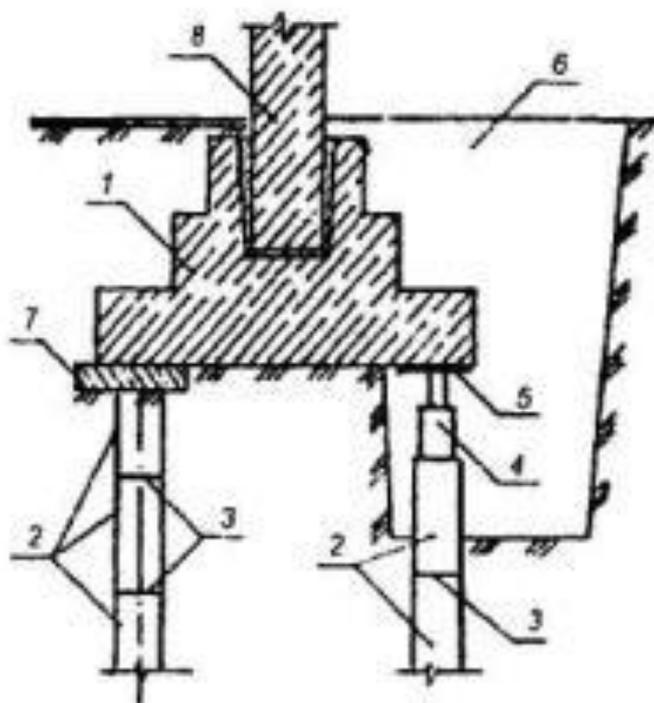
1 - усиливаемый столбчатый фундамент; 2 - звенья составных железобетонных свай: 3 - стыки свай; 4 - гидравлический домкрат; 5 - металлическая подкладка; 6 - шурф; 7 - монолитная железобетонная плита (устраиваемая участками после вдавливания свай); 8 - железобетонная колонна.
